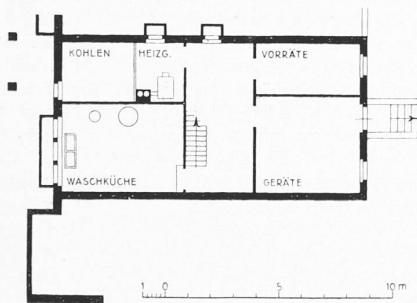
bis 3. Grundrisse des Hauses Dr. E. Laur in Thalwil (Zürich). — Masstab 1 : 300
